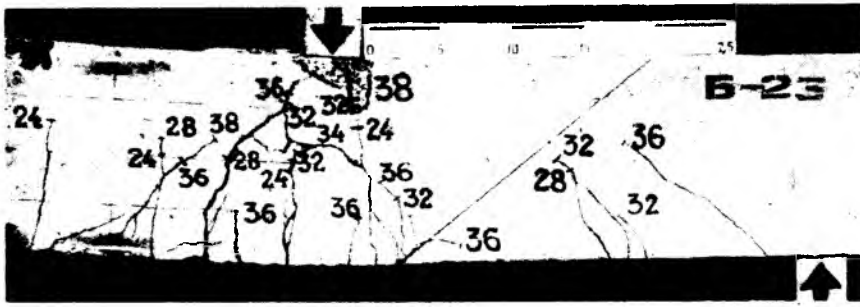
Образование и развитие трещин в балке Б-23 с одной наклонной пластиной в сочетании с поперечной арматурой
